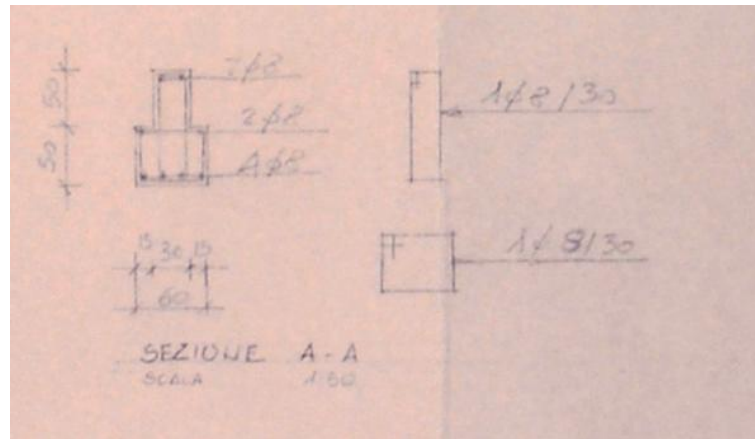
Particolare di A.1990.cap.us.T06 - Pianta delle fondazioni - Sezione tipo cordolo di collegamento
